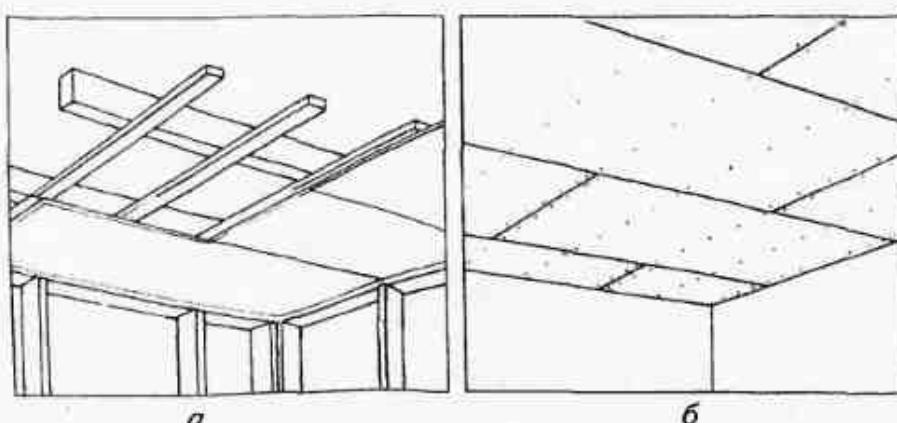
Схема устройства подшивного потолка (а) и общий вид (б)
